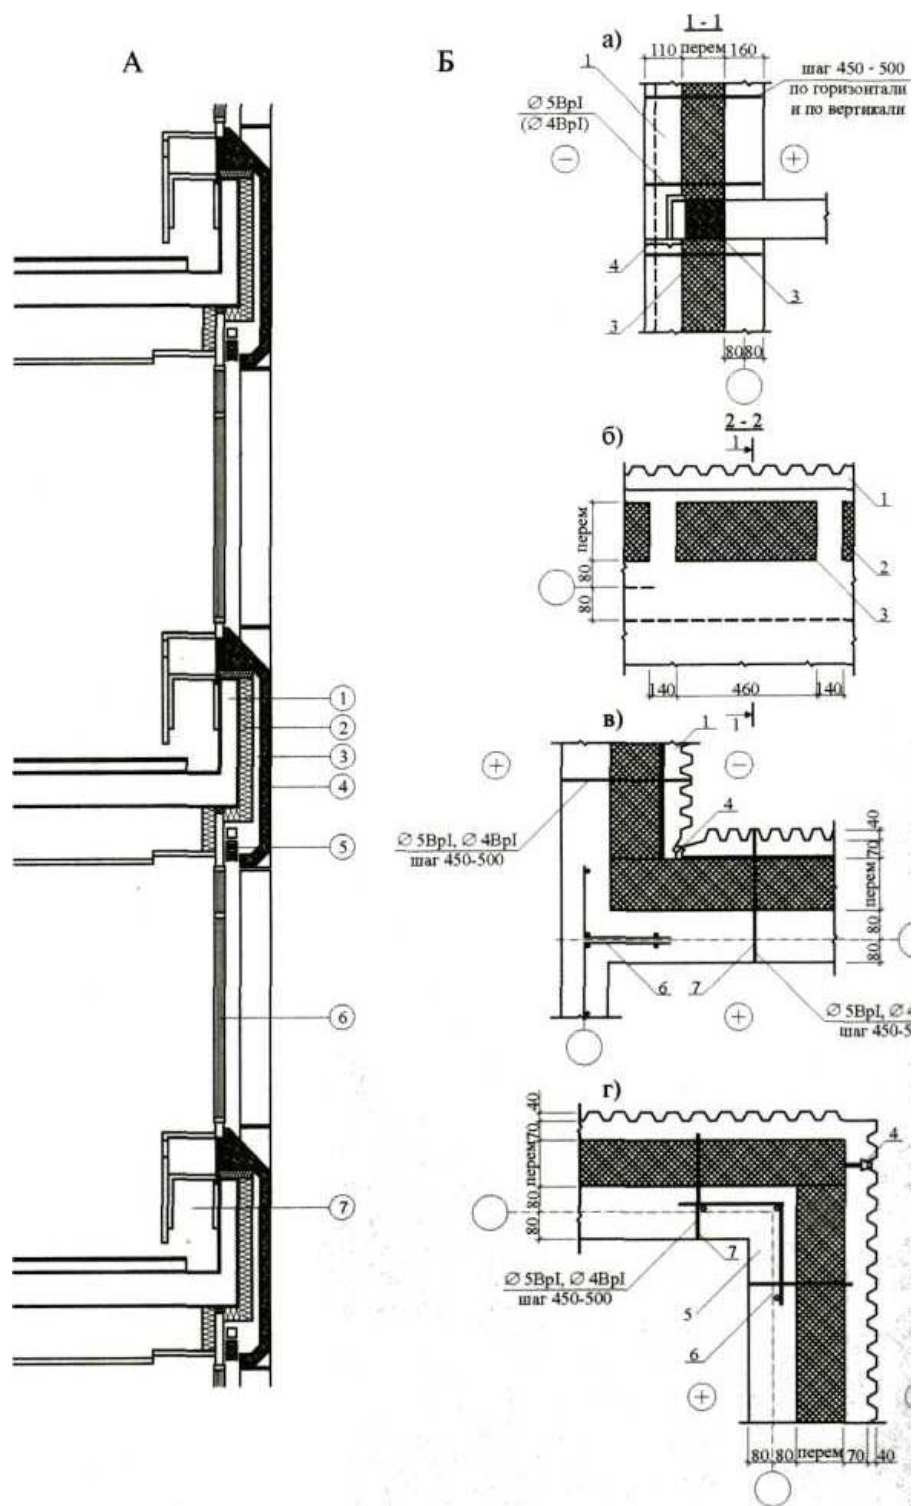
Примеры облицовки наружных монолитных стен профилированными крупными железобетонными панелями: А - из практики ФРГ: 1 - внутренний бетонный слой стены 2 - утеплитель, 3 - вентилируемая воздушная прослойка, 4 - облицовочная панель, 5 - жалюзи 6 - оконный блок, 7 - отопительная система; Б - из отечественной практики: а - вертикальное сечение стены, б - горизонтальное сечение рядовое, в - то же во входящем, г - тоже в выступающем углу наружных стен: 1 - облицовочная рифленая панель, 2 - перфорированный участок плиты перекрытия, 3 - негорючий утеплитель, 4 - упругая прокладка, 5 - внутренний бетонный слой, 6 - гнутый арматурный каркас, 7 - арматурная связь
